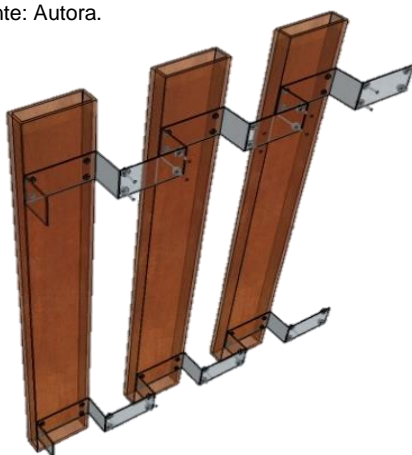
Sistema de brisesoleil com encaixe metálico.
